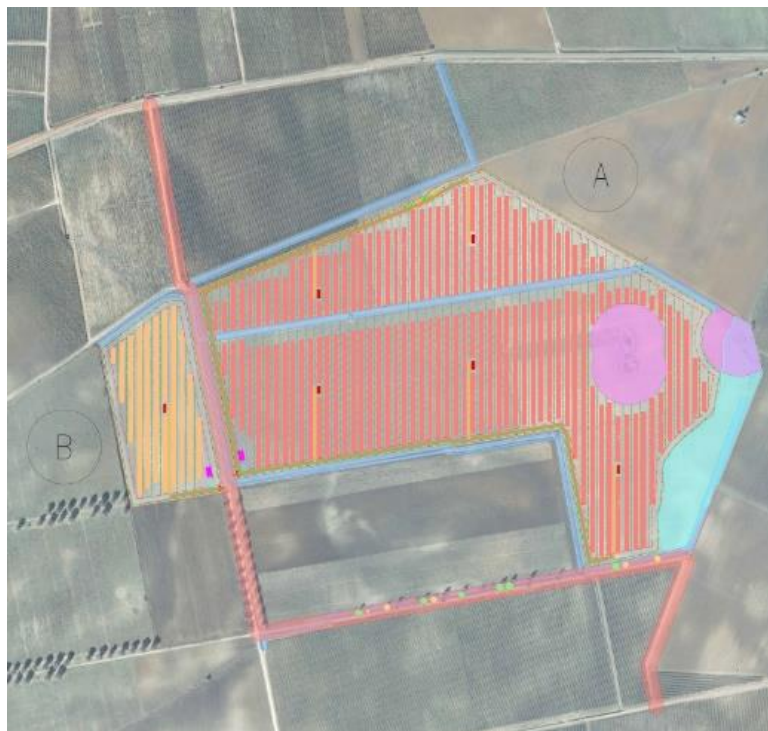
Perimetrazione sito e fascia di rispetto di 5 metri (in blu) e stralcio PAI-pericolarità media (azzurro).
